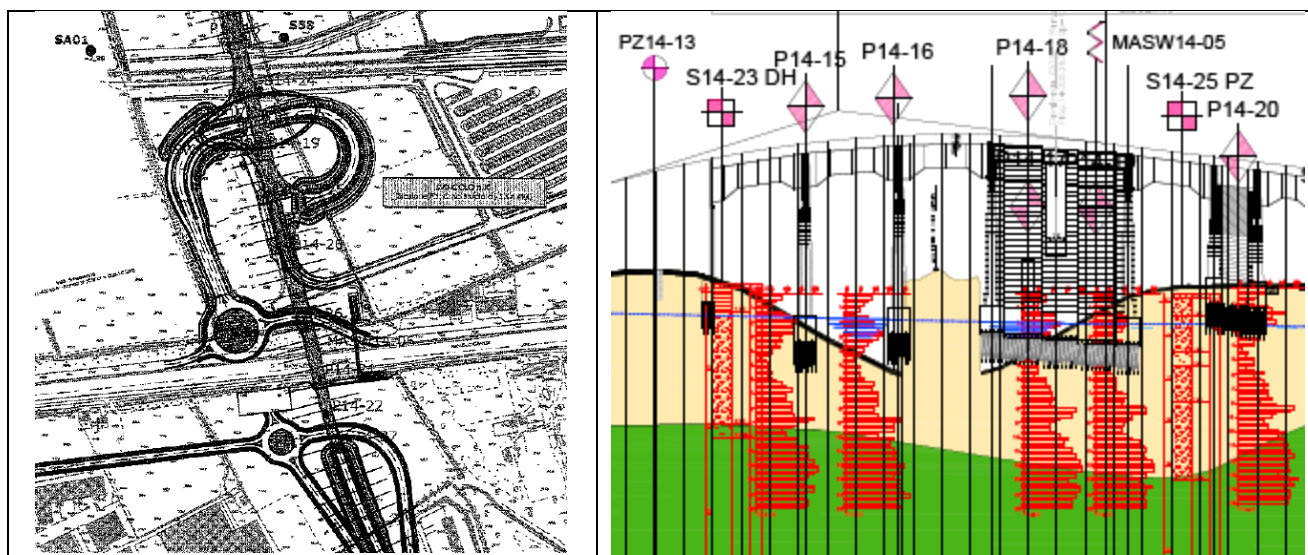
Stralcio planimetrico e stralcio profilo geologico Svincolo 10
